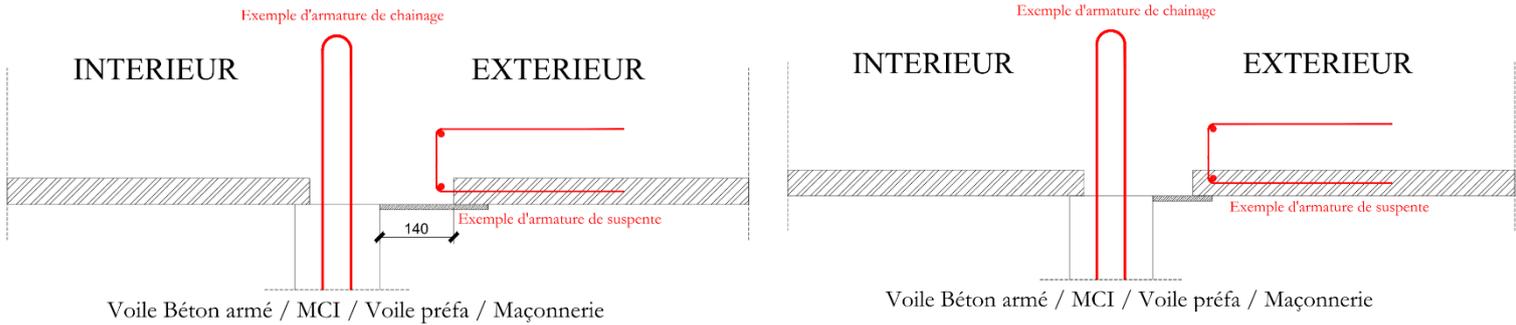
Détail avant mise en place des rupteurs et des aciers, à gauche dans le cas d'un décalage de la prédalle, à droite dans le cas où la prédalle est positionnée au nu du rupteur
